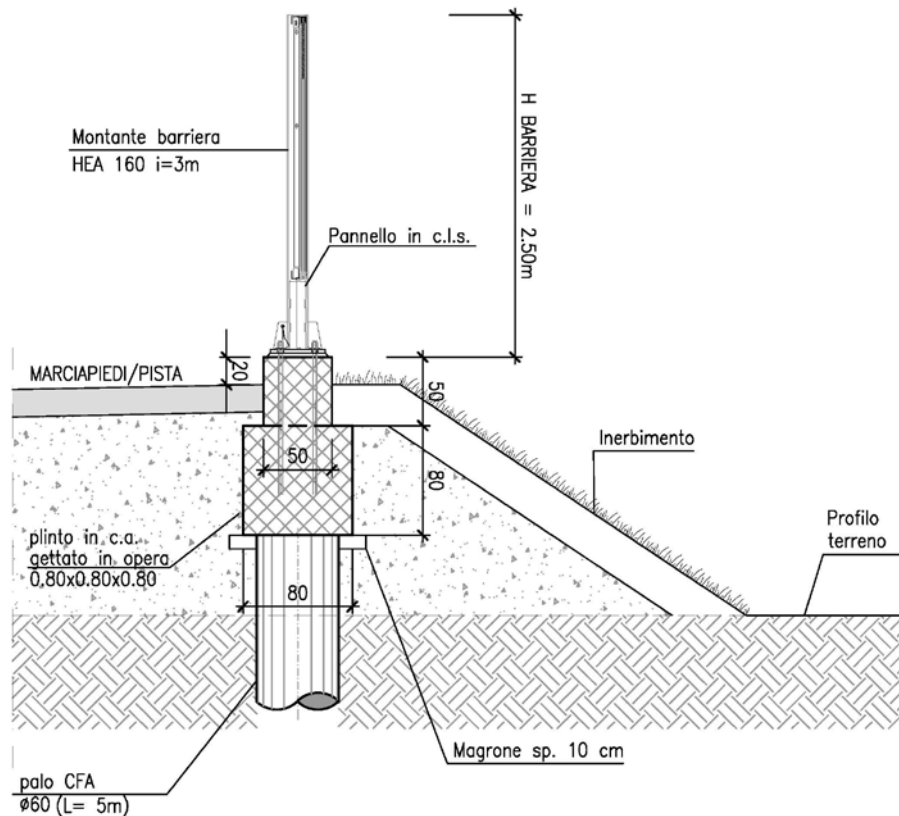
Barriere acustiche B3 – Sezione trasversale
